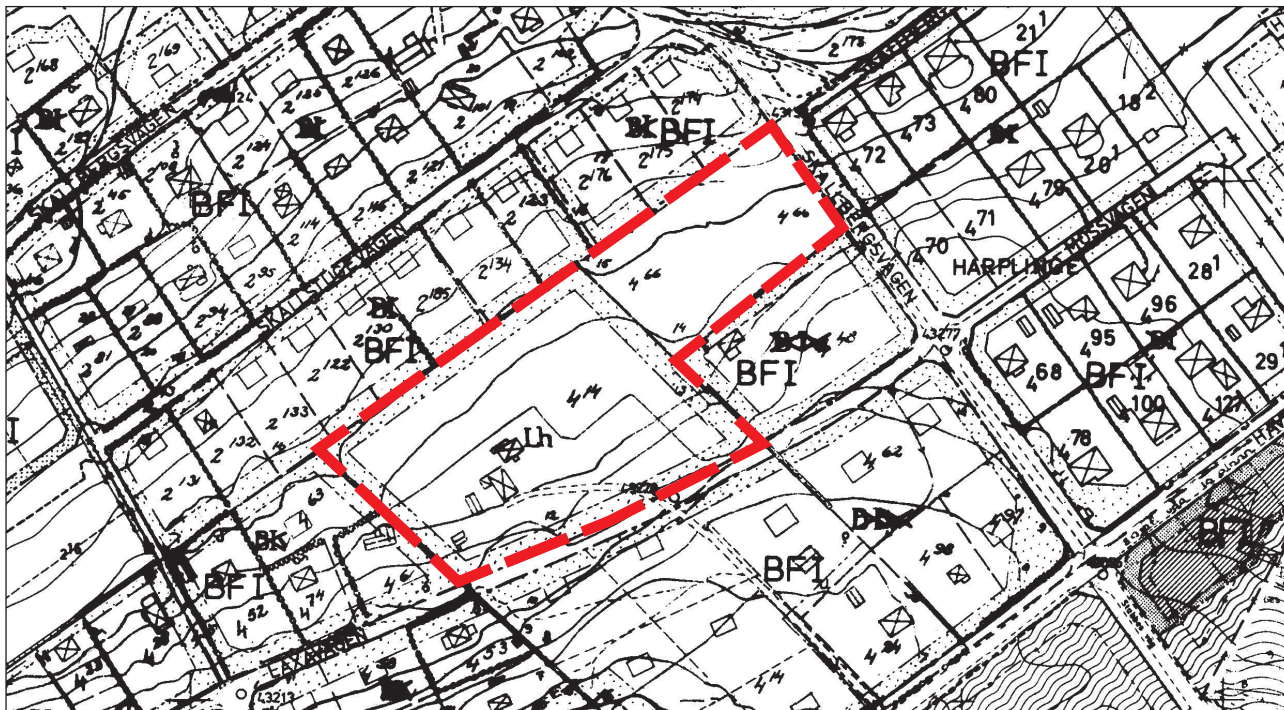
Utdrag ur gällande plan, 1380K-P625. Röd streckad planområdesgräns.
